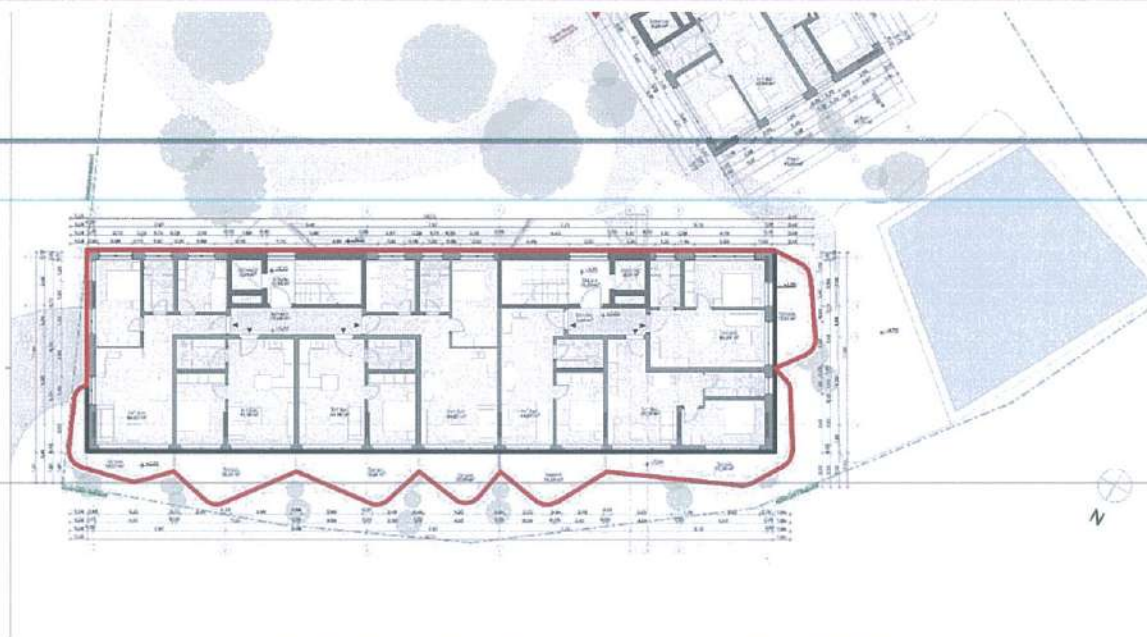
Planimetria e katit të parë – Sip. kati të parë 588.6m²
